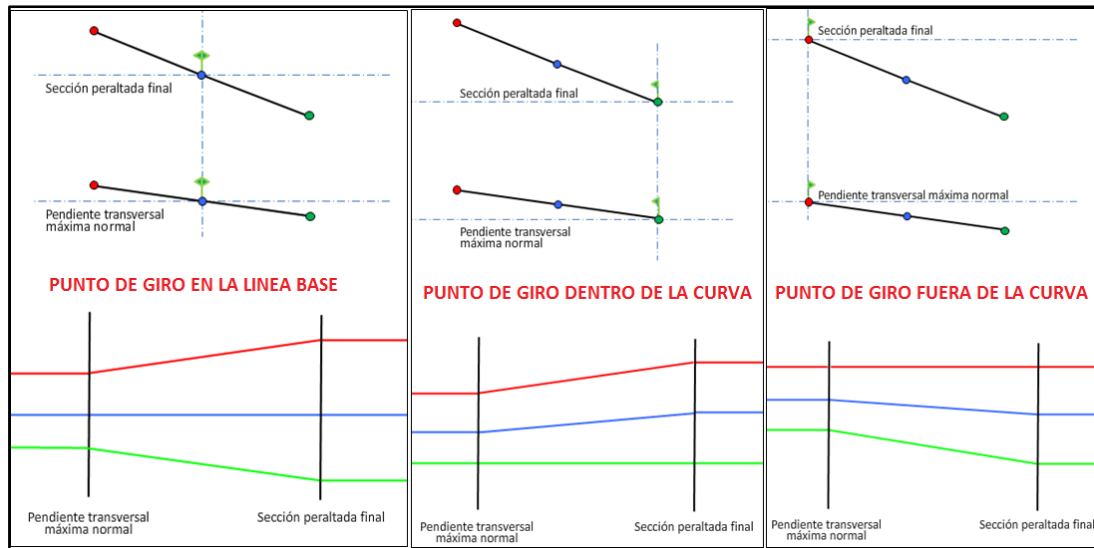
135 Peralte calzada con sección transversal punto giro lado izquierdo
